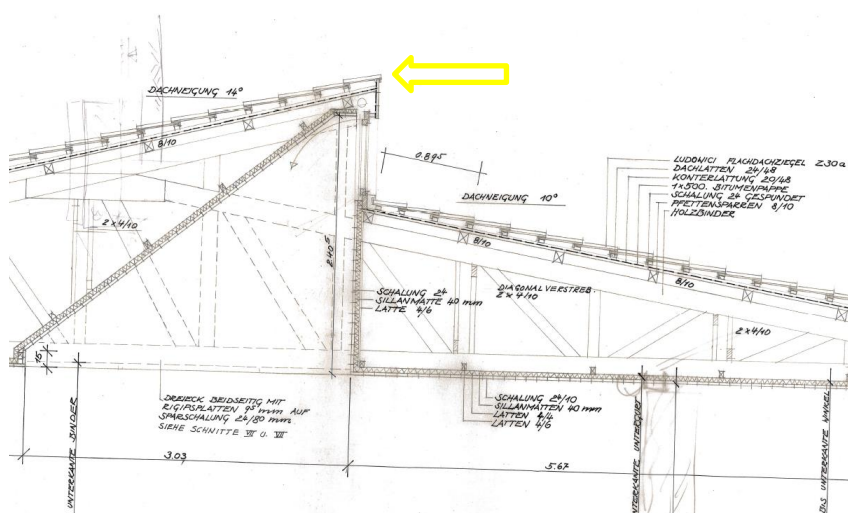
Dachkonstruktion über dem Gemeindesaal, Quelle: Ausführungsplanung 1965
